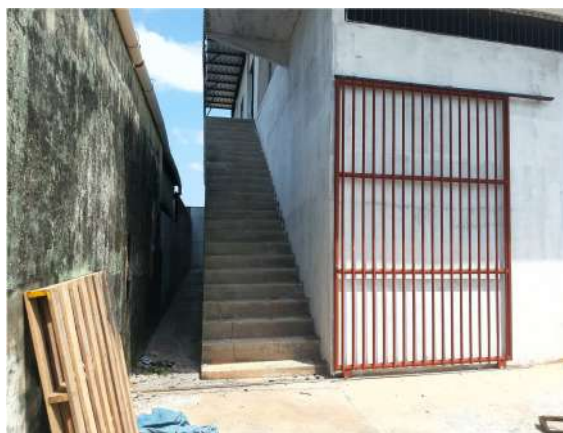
IMÓVEL 2 – Escada de acesso ao pavimento superior.
